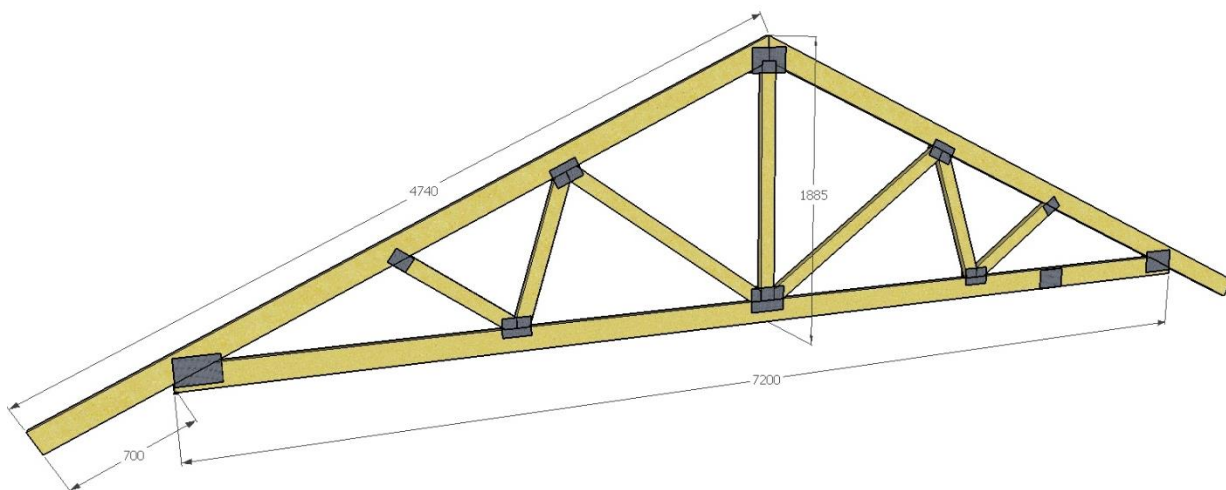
Конструкция фермы треугольного очертания с узлами на МЗП
